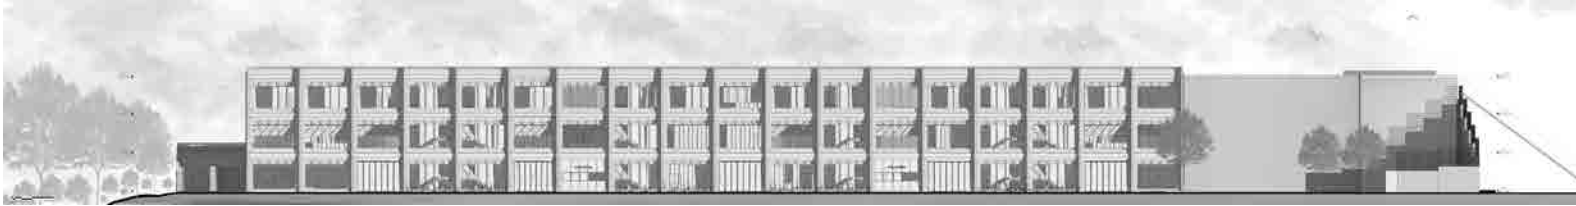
Elevación lateral derecha. Elaboración: Autores.
